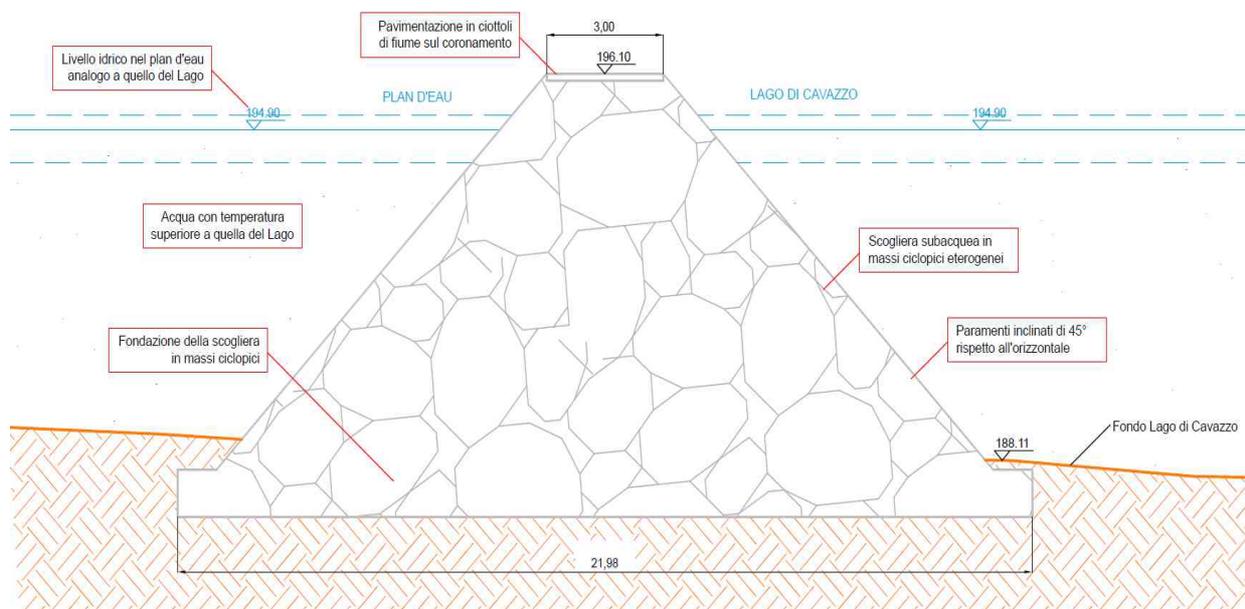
Sezione tipo della scogliera presso il plan d'eau n. 1.
